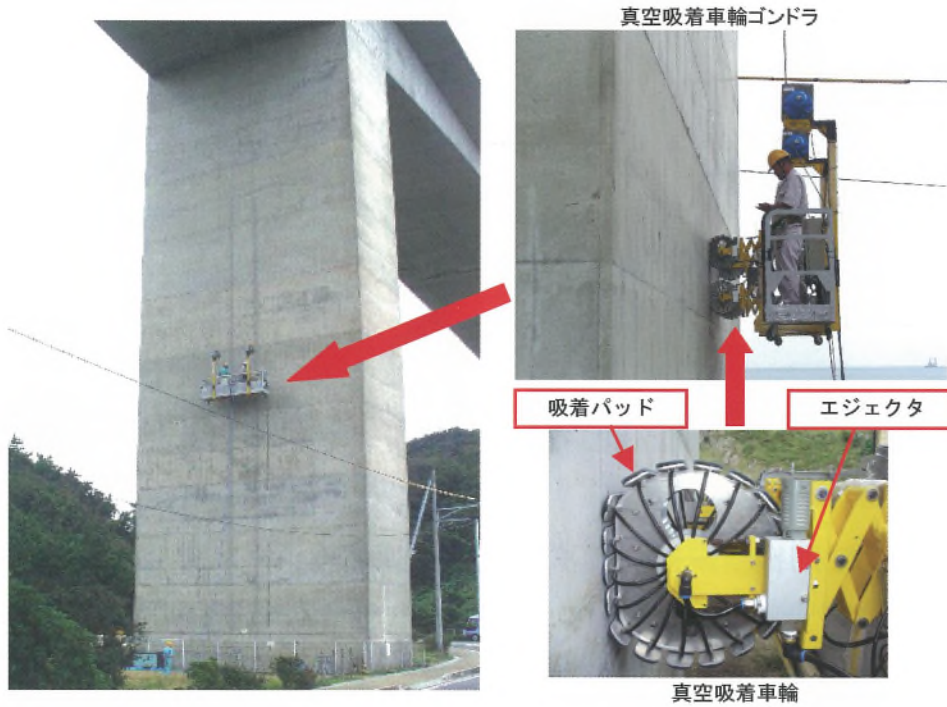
コンクリート構造物の点検と補修(亀浦高架橋7P)
